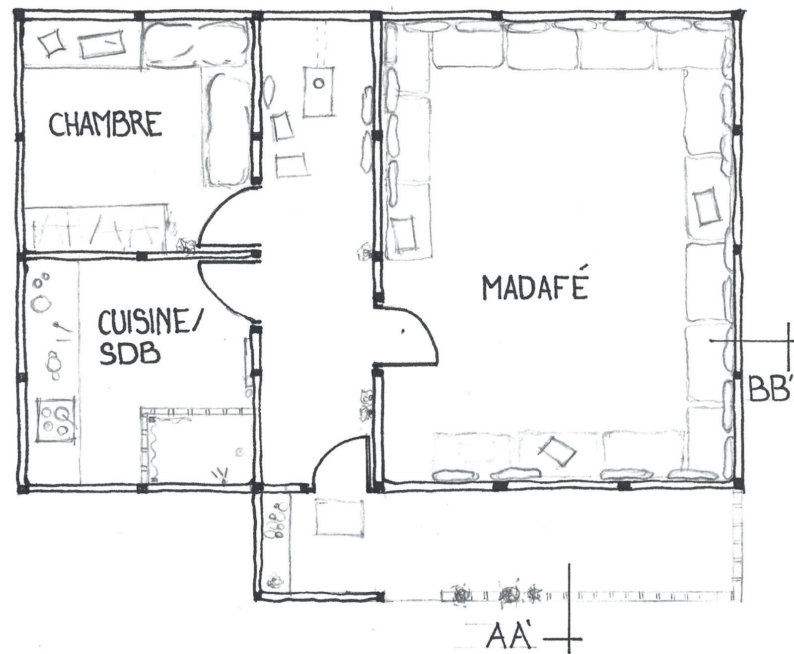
Camp Merkebta 047, plan de l'espace domestique.
